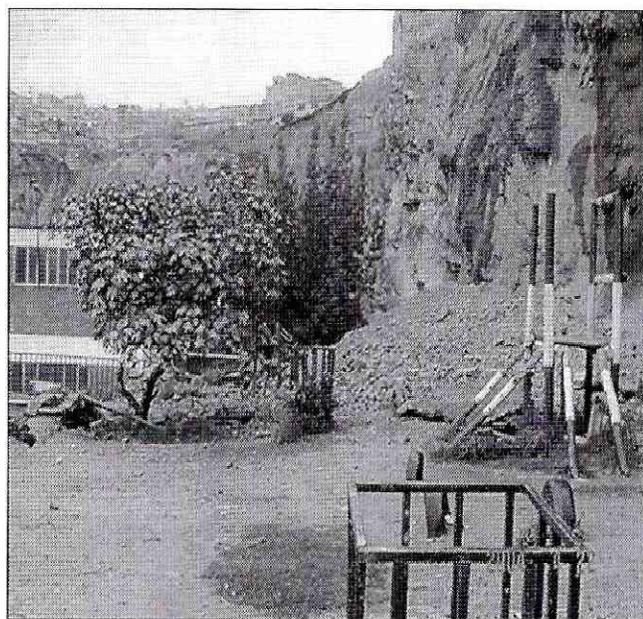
Vista de los juegos infantiles ubicados de manera inapropiada en la zona de aislamiento de la obra de protección del escarpe.
